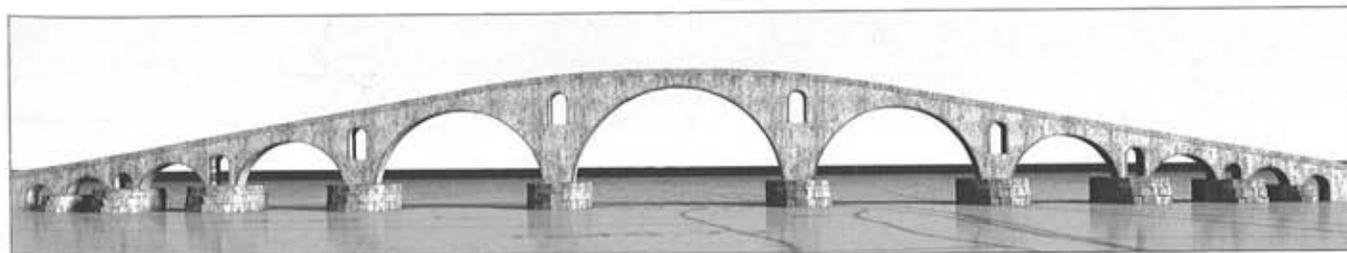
Propuesta de reconstrucción del antiguo puente de Casas del Puente.
